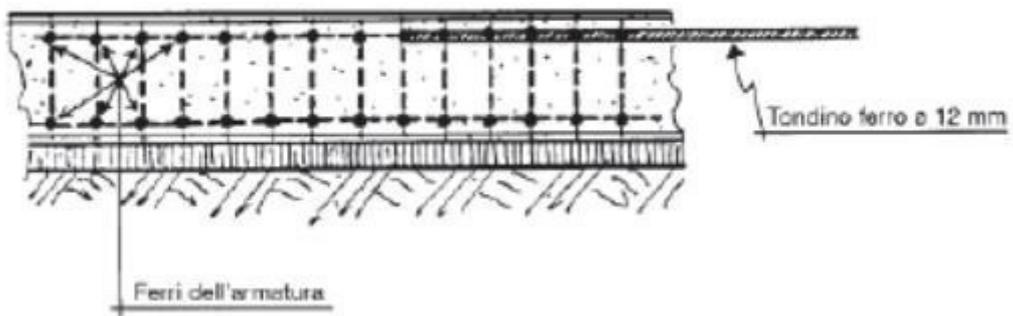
Esempio di platea di fondazione con connessione ai ferri dell'armatura
